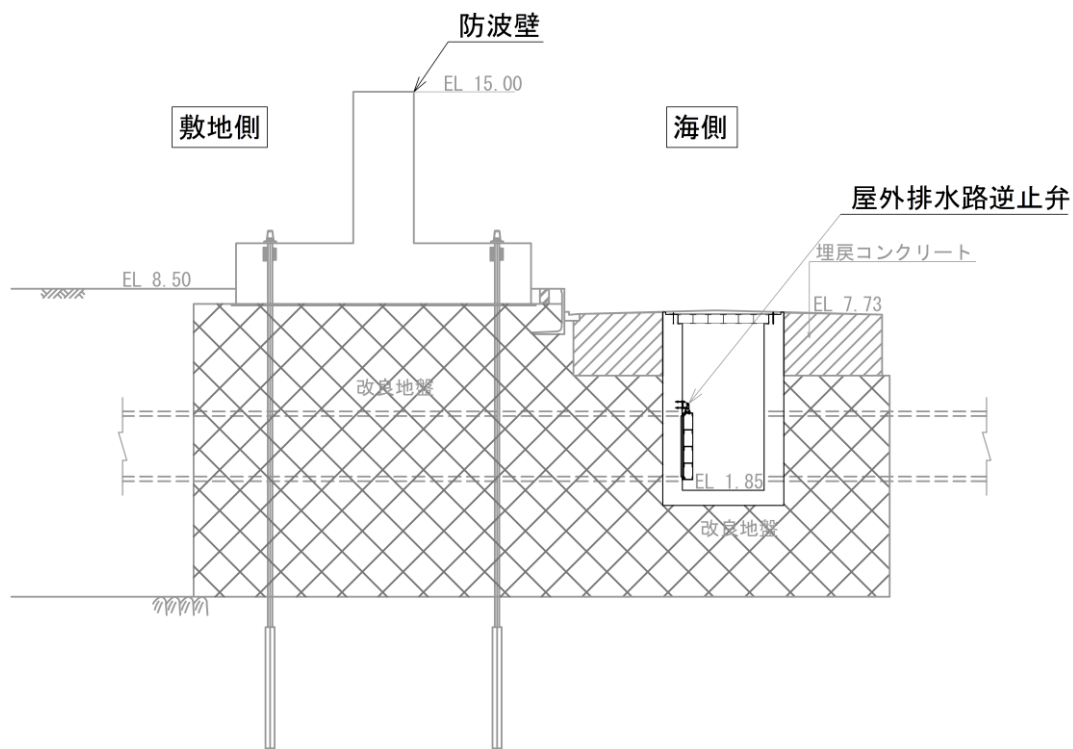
(1) 屋外排水路逆止弁⑨断面図
